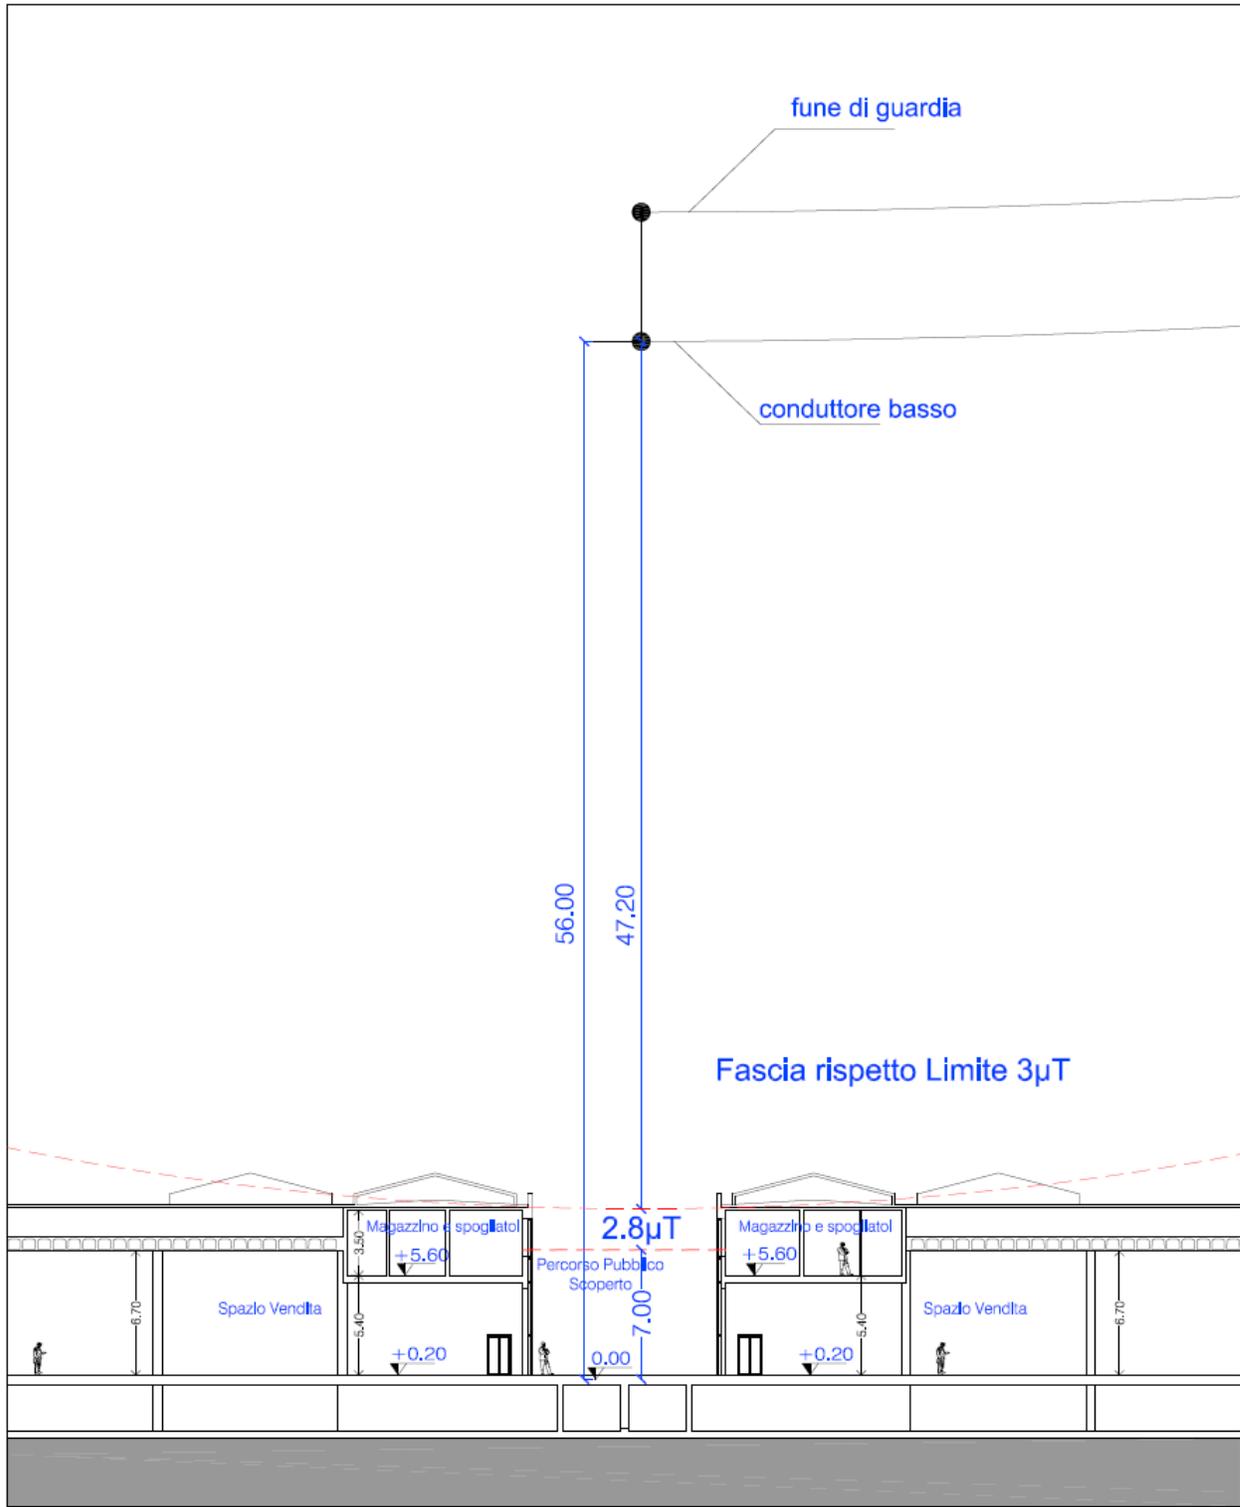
Parco commerciale, sezione B-B' (stralcio),
